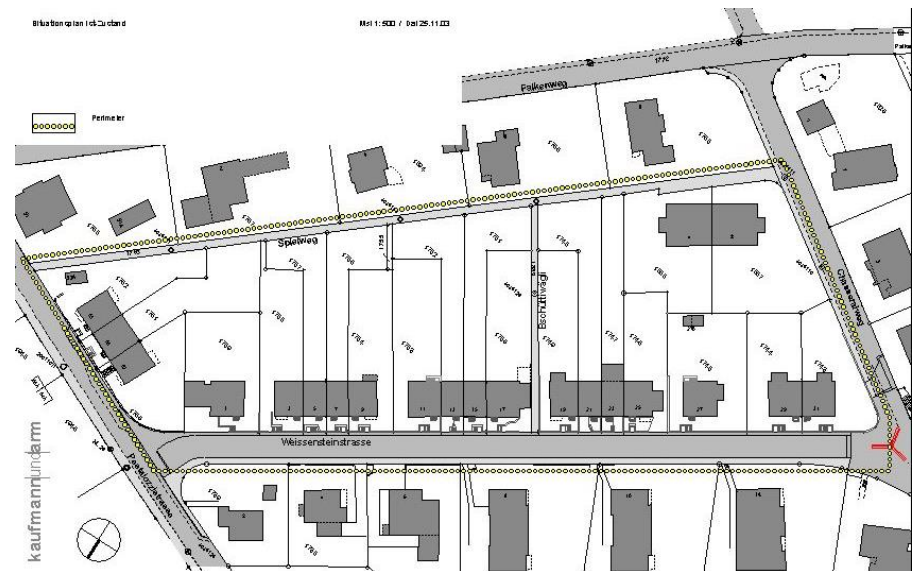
Perimeterplan des Strukturgebiets Weissensteinstrasse
